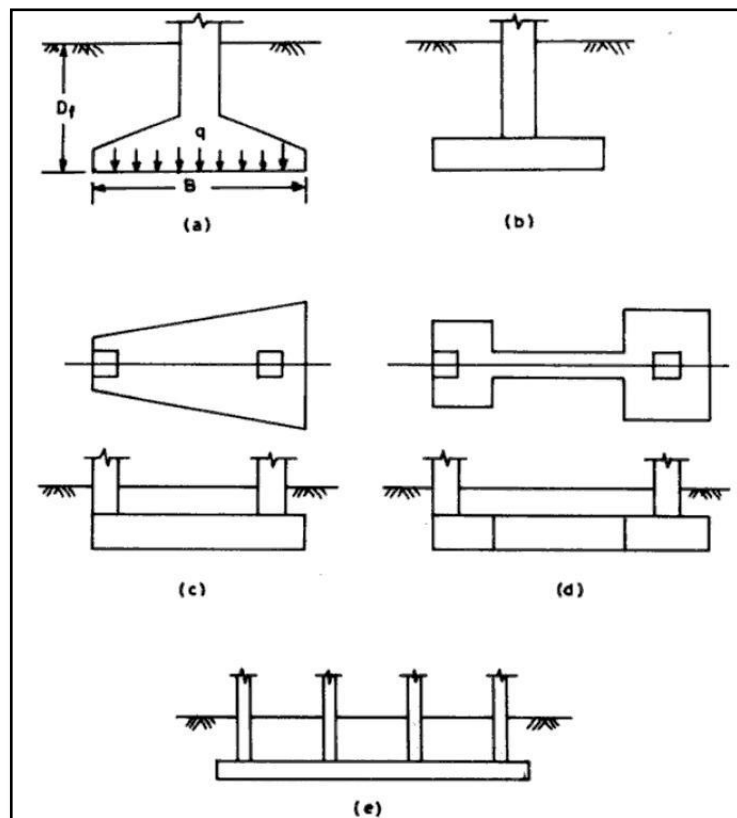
a) zapata de peralte variado, b) zapata de peralte uniforme, c) zapata combinada con losa variable, d) zapata conectada por viga de cimentación y e) zapata continua o losa (placa) de cimentación.
